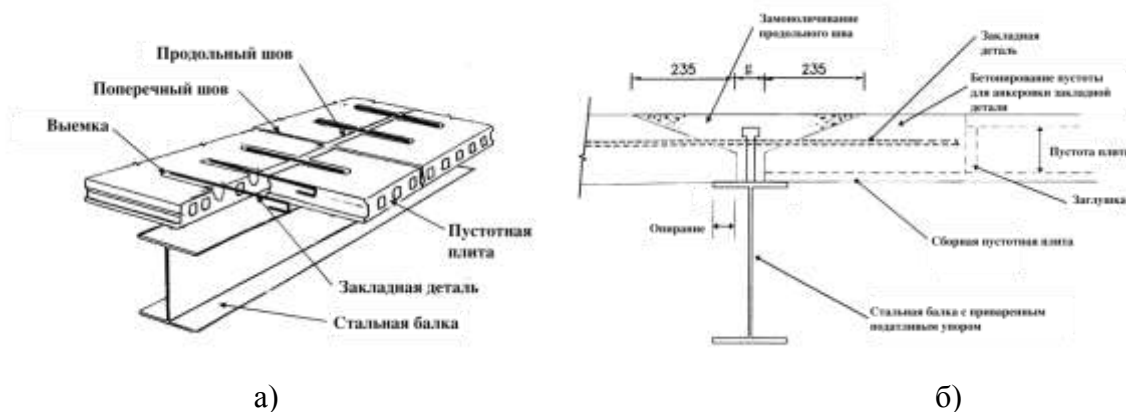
Устройство податливых упоров сталежелезобетонного перекрытия
